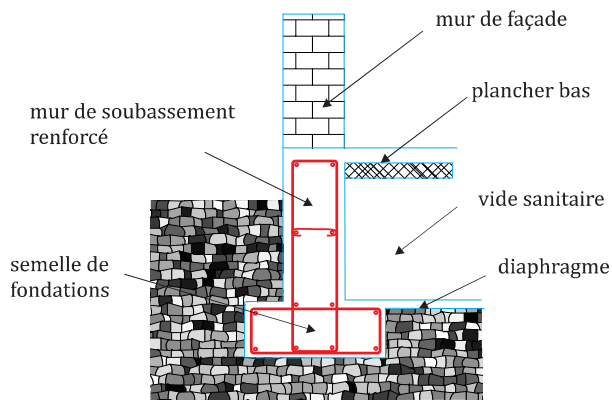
Principe de fondation avec mur de soubassement renforcé
